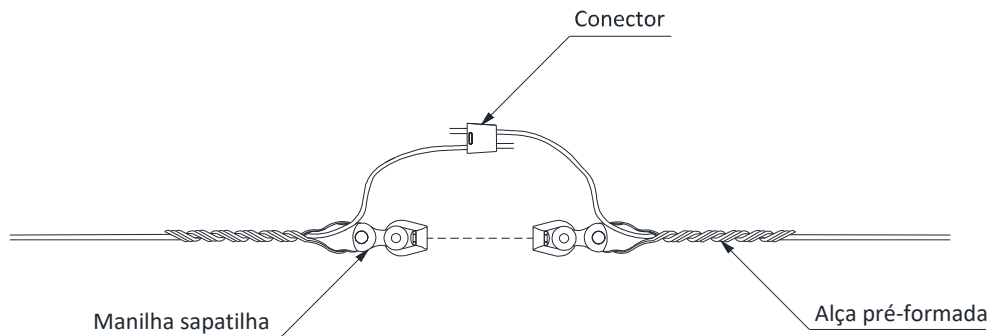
Amarrações e ligações – Ancoragem dupla – Mensageiro
